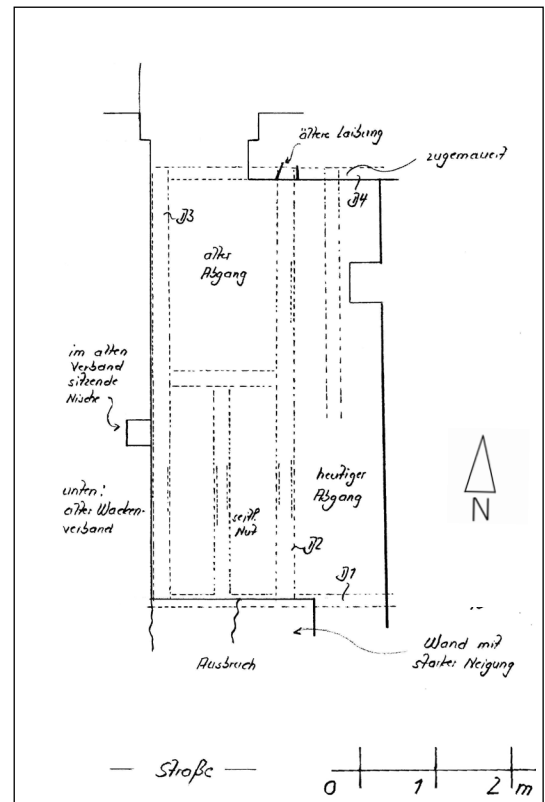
Spitalstraße 13, Grundriss Keller.
